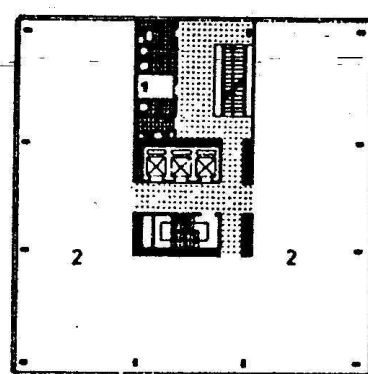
Висотні будівлі. (Нойферт Э. Строительное проектирование. -: Стройиздат, 1991. - 392 с.)
